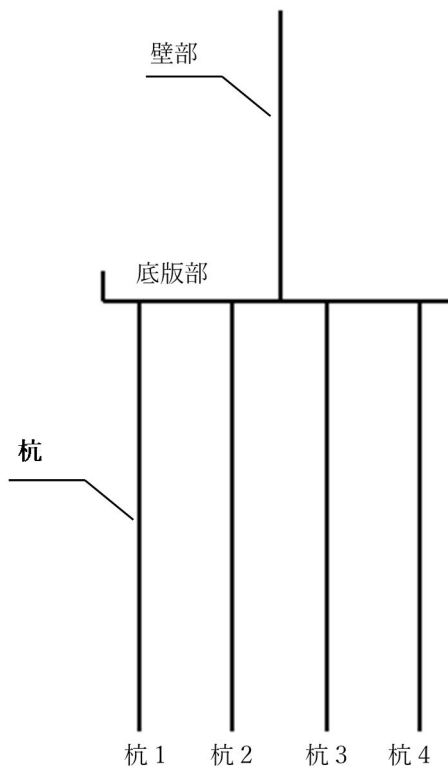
防潮扉2基礎 杭番号位置図
